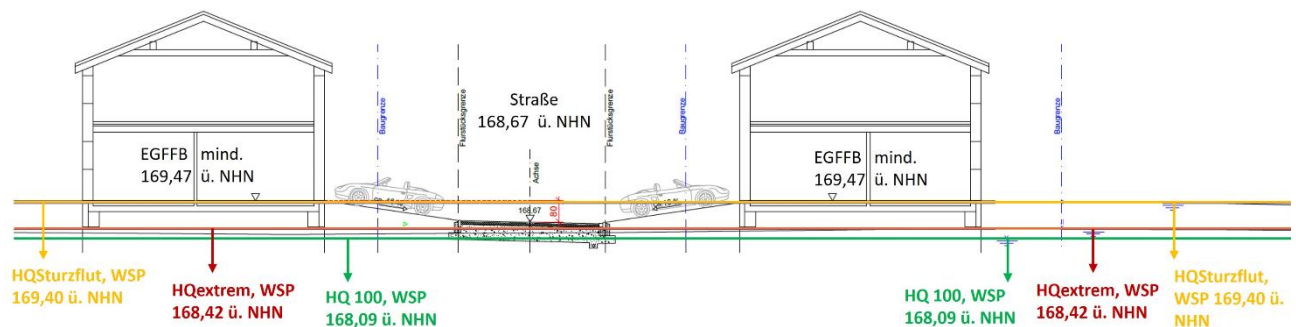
Schnitt durch Grundstücke mit der Kennziffer 10 mit Kennzeichnung der Wasserspiegellagen HQ100, HQextren und HQ Sturzflut
